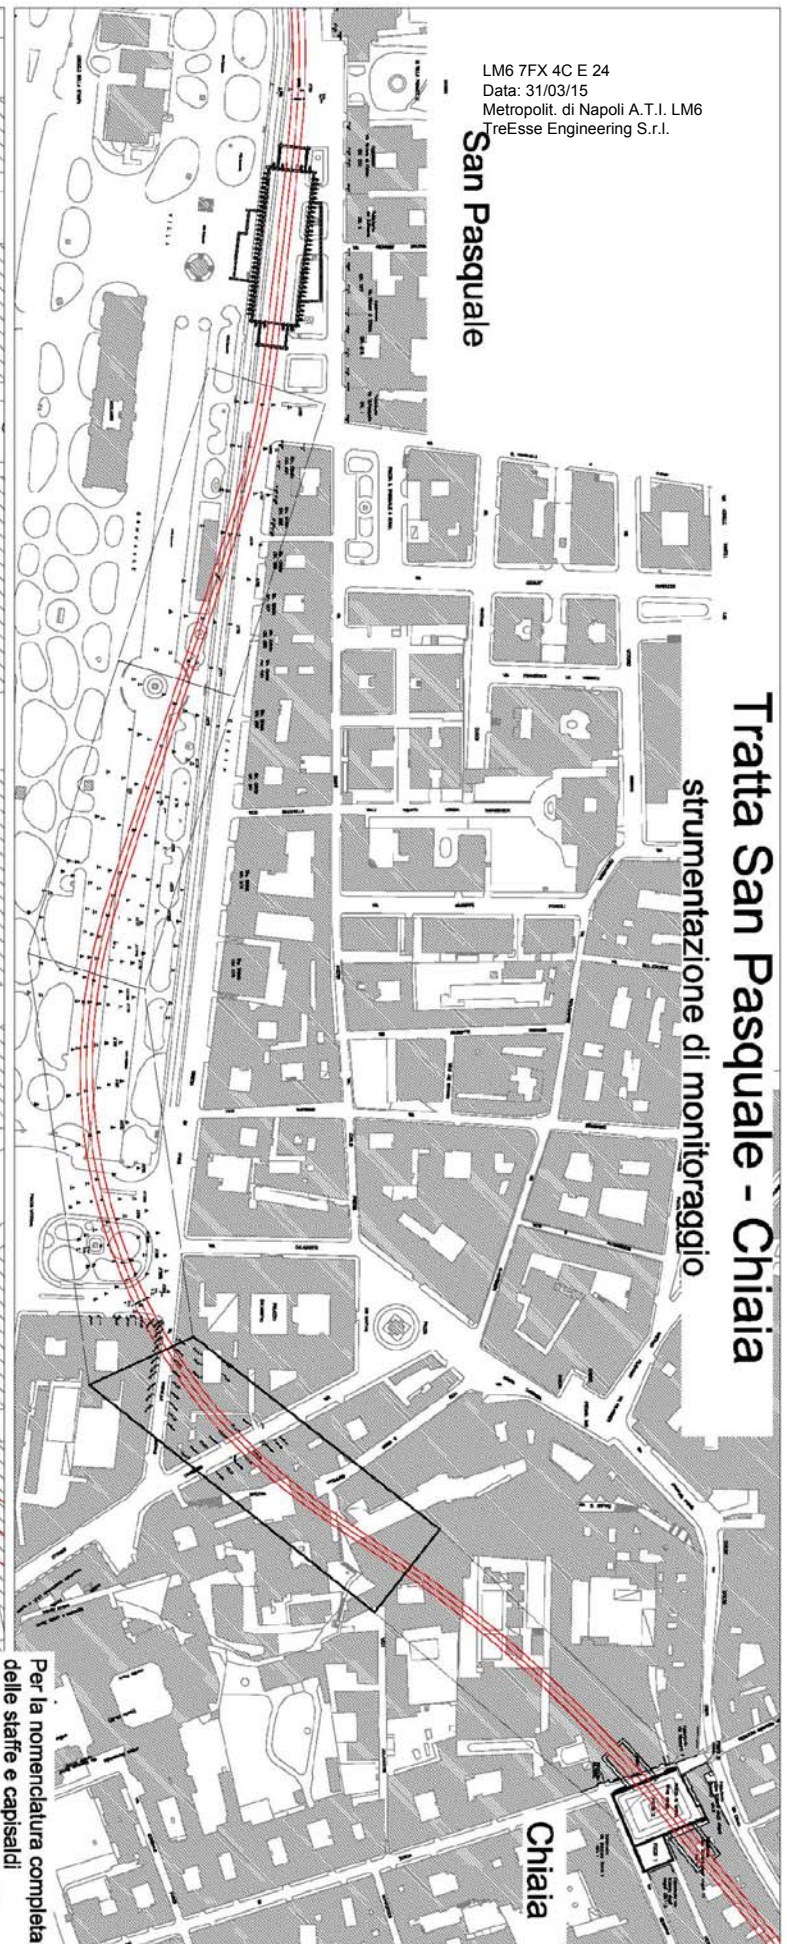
Planimetria tratta San Pasquale - Chiaia, raffigurante la disposizione della terza installazione della strumentazione di monitoraggio.
